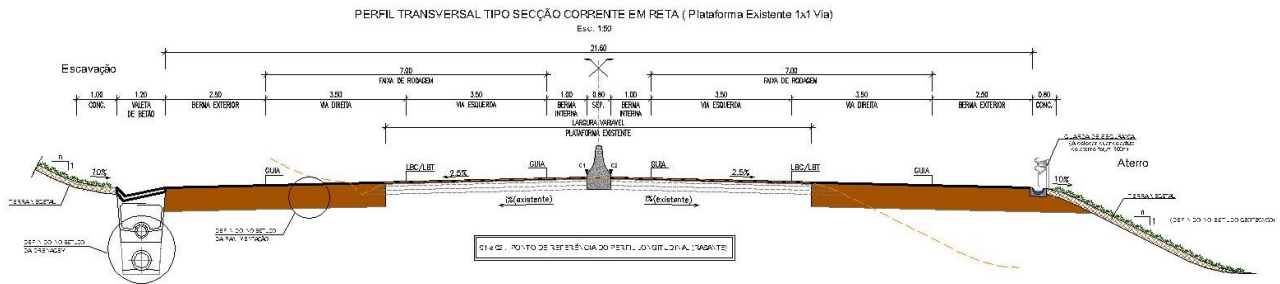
Perfil transversal tipo da seção corrente em reta, adotado para plataforma existente para via 1x1
